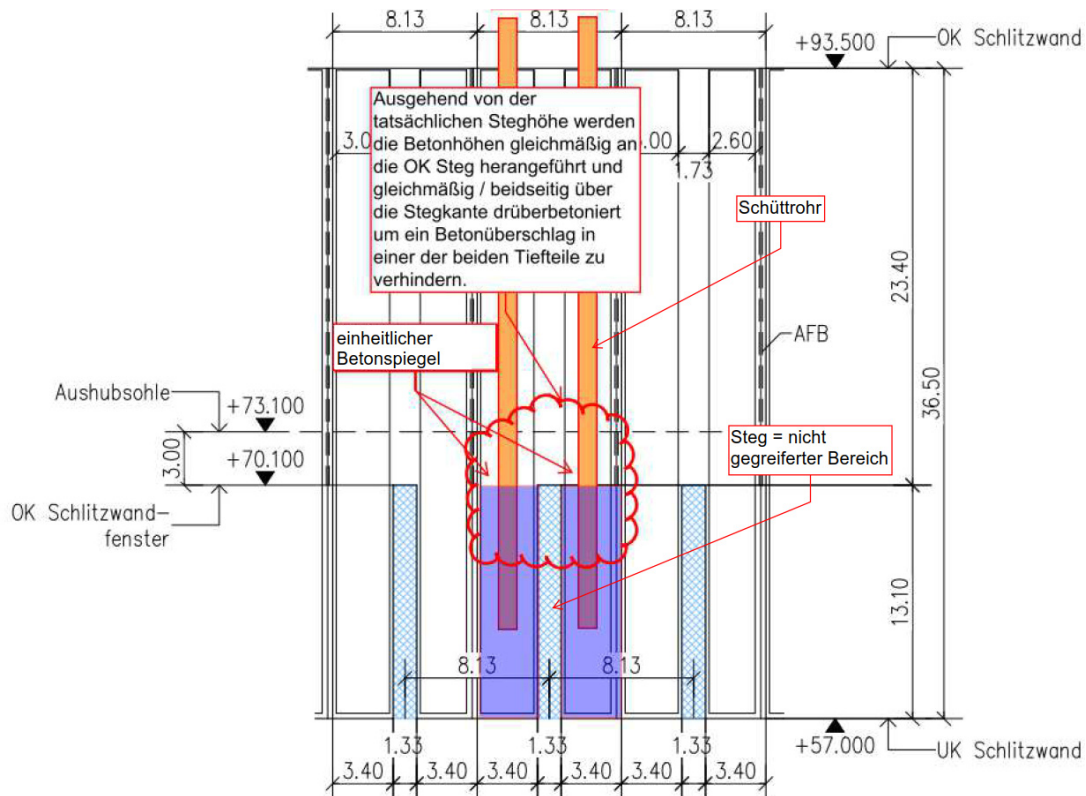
Auszug aus dem QS-Plan – Betonage im Stegbereich
